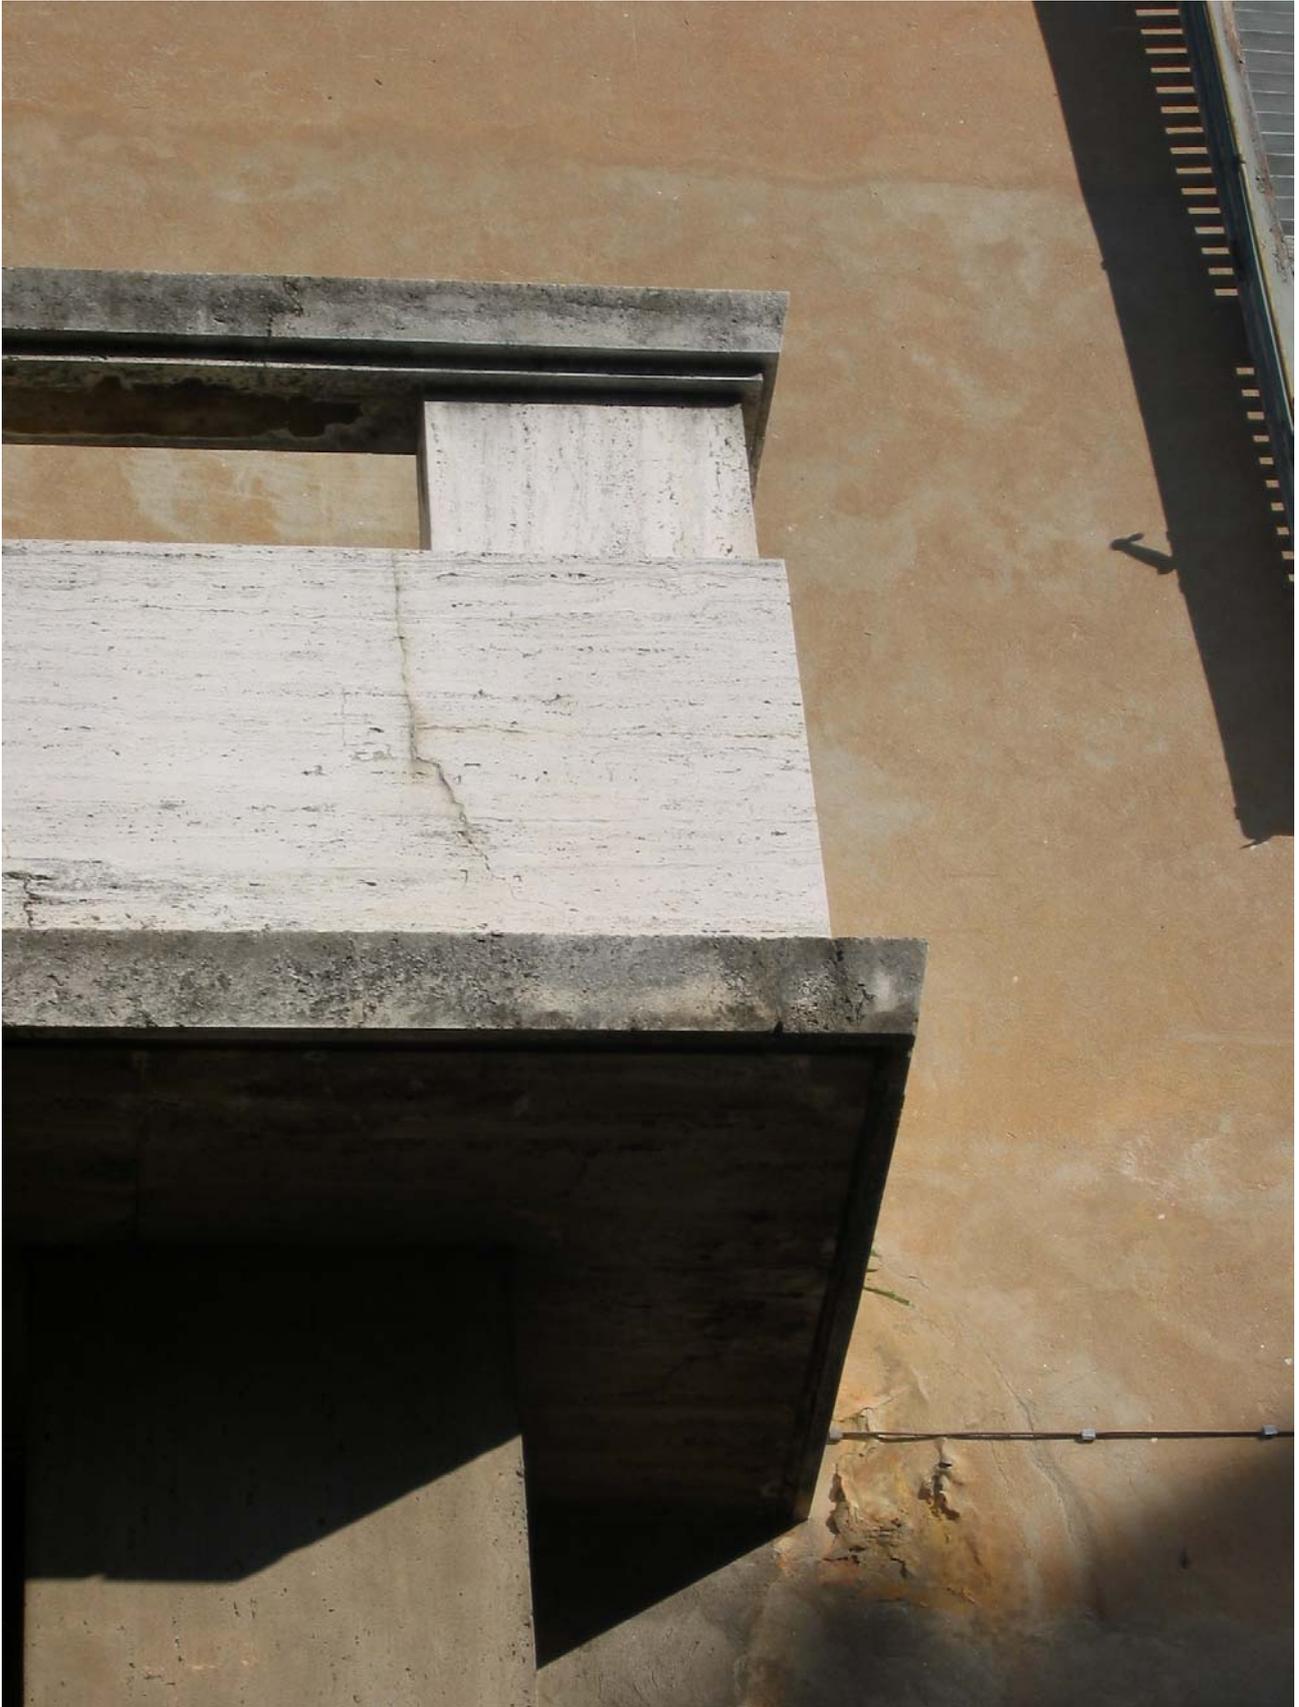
Particolare della facciata principale su via Luca della Robbia – danni provocati dalle infiltrazioni di umidità (prospetto A)
